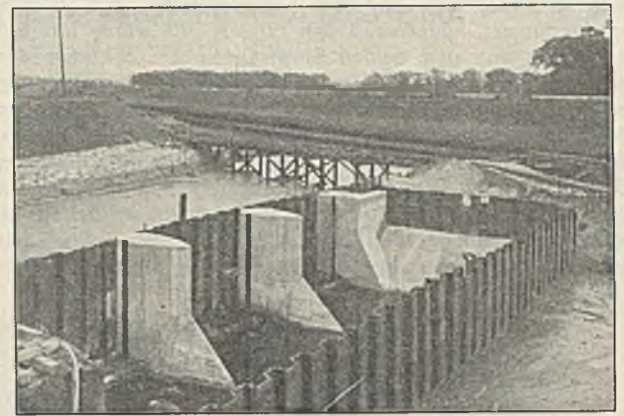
Baugrube des Grundablasses (Boyewehr).
